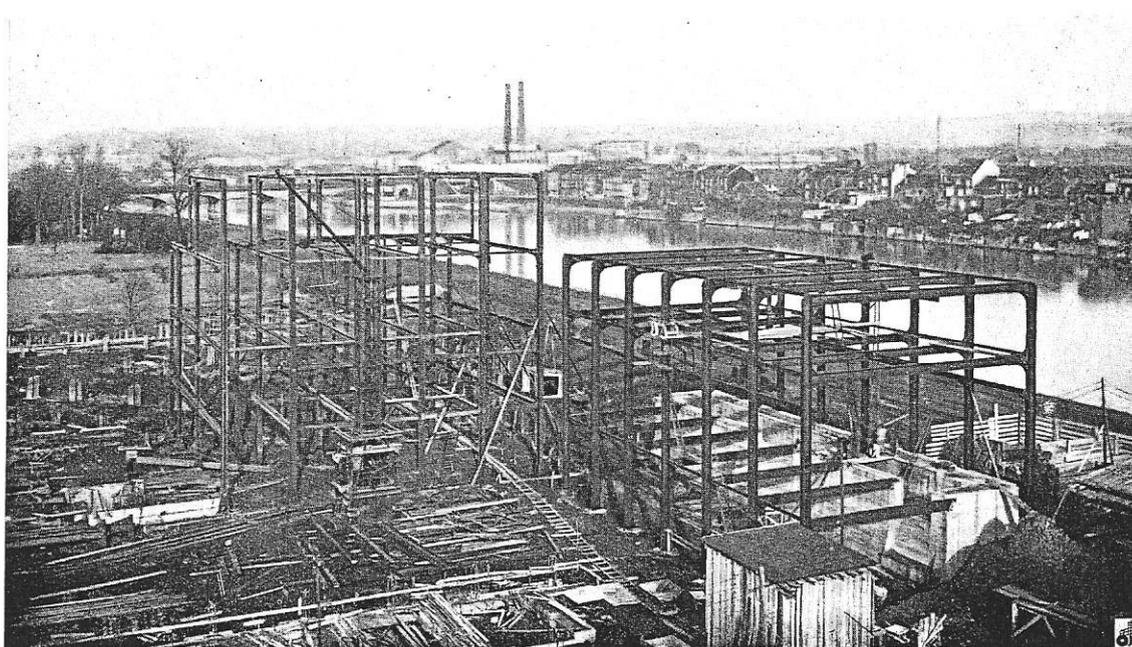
Chantier des instituts universitaires du Val-Benoît.
